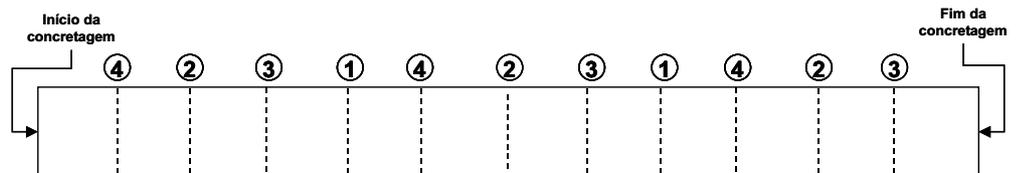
Plano de corte de juntas transversais - seqüência de corte
